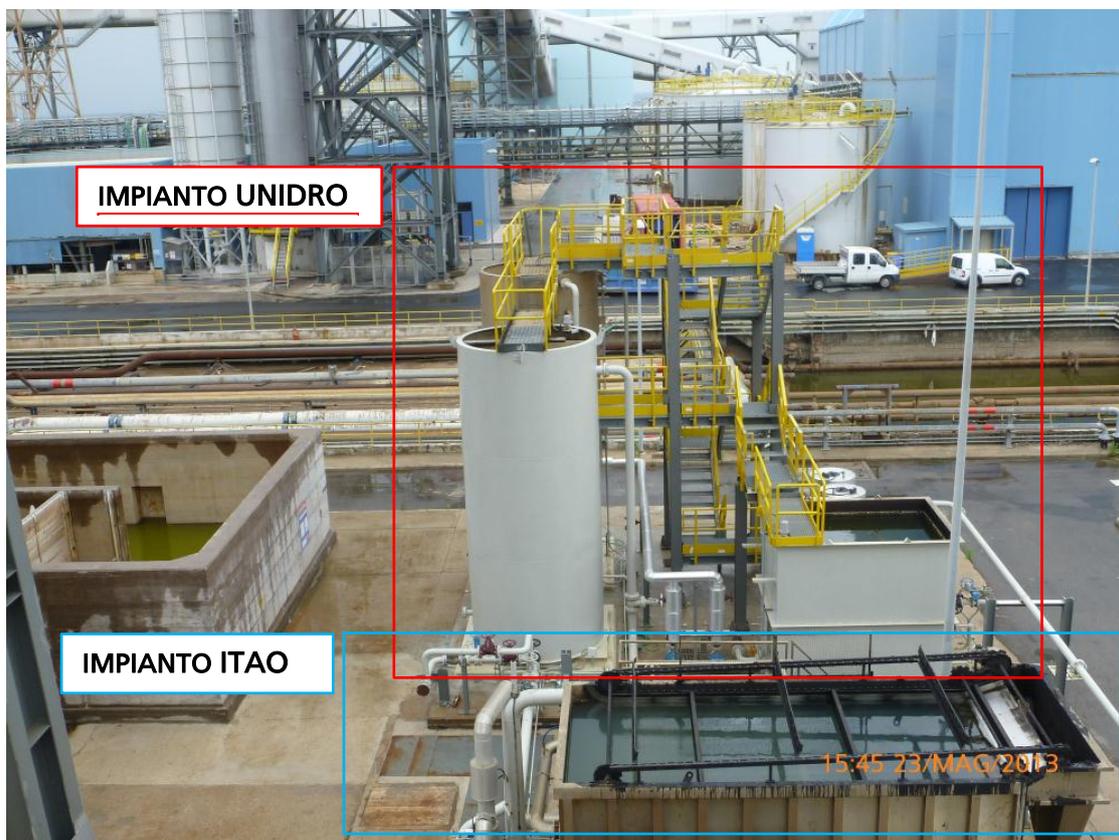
Nuova posizione dell’impianto UNIDRO, vista dall’alto
